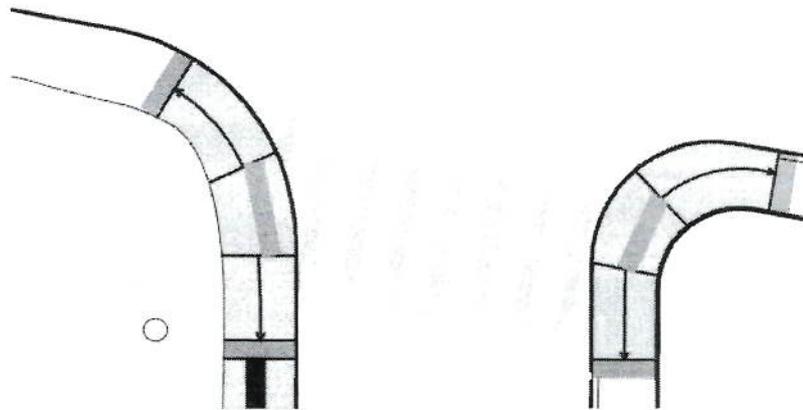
Rebaixamento de calçada entre canteiros – Exemplo
